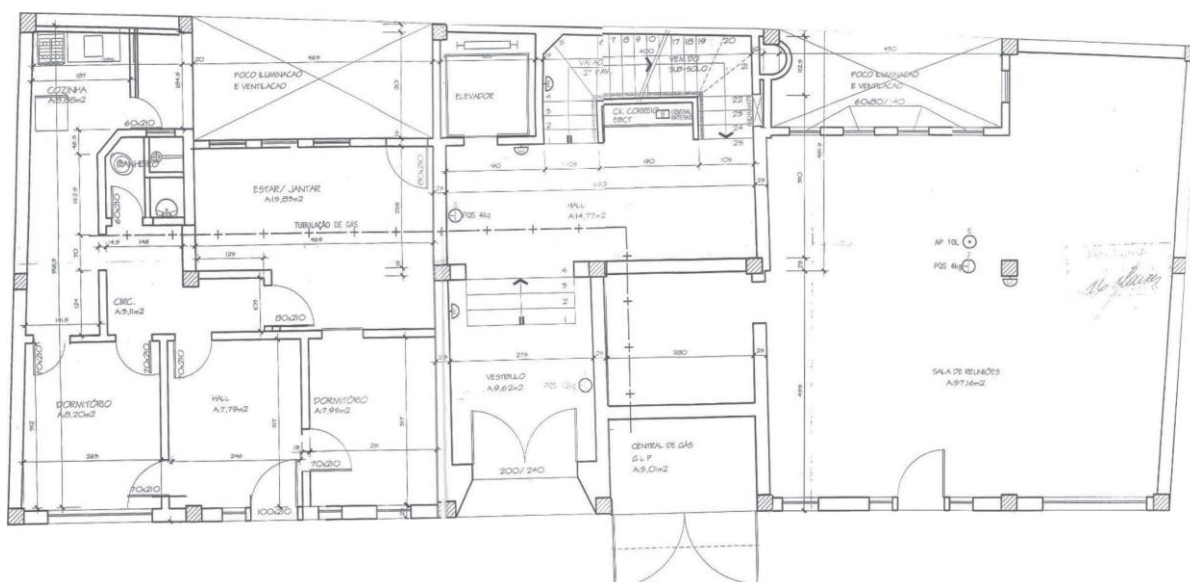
Plano de la Planta sótano -1 del Edificio “Utopia e Luta”.
